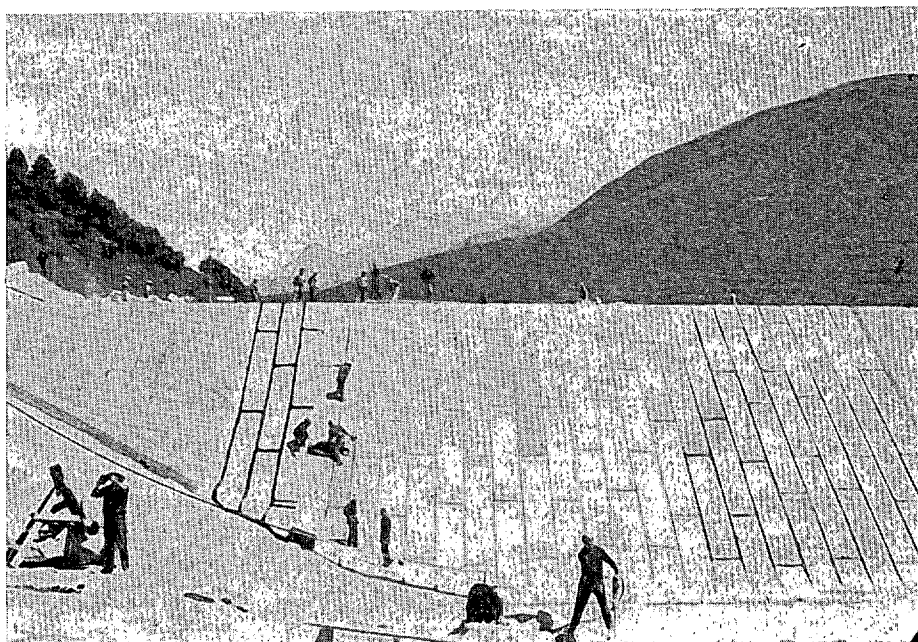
Colocación de telas impermeables en primera etapa. En el centro, capa de butapreno colocada. Los obreros colocan la segunda capa de neopreno-nylon.
